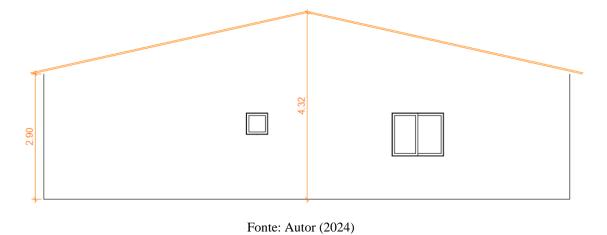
Fachada lateral esquerda da casa de alvenaria
